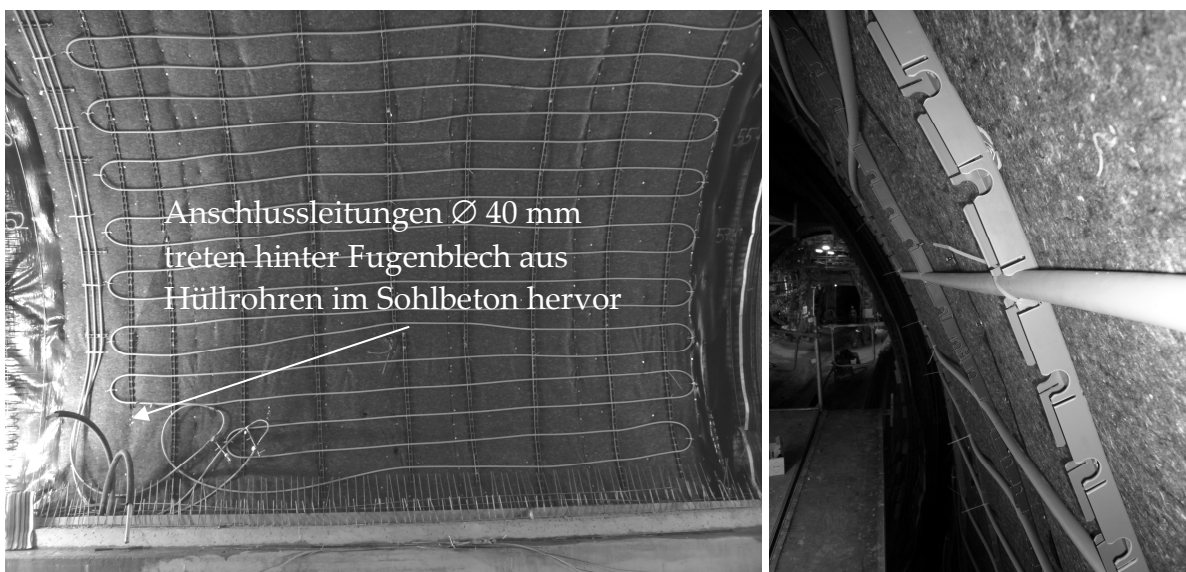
Links: Ansicht der nördlichen Ulme im Block 82. Rechts: Auf dem Geotextil über der Spritzbetonschale befestigte Fixierschienen als Montagehilfe für die Absorberleitungen.
